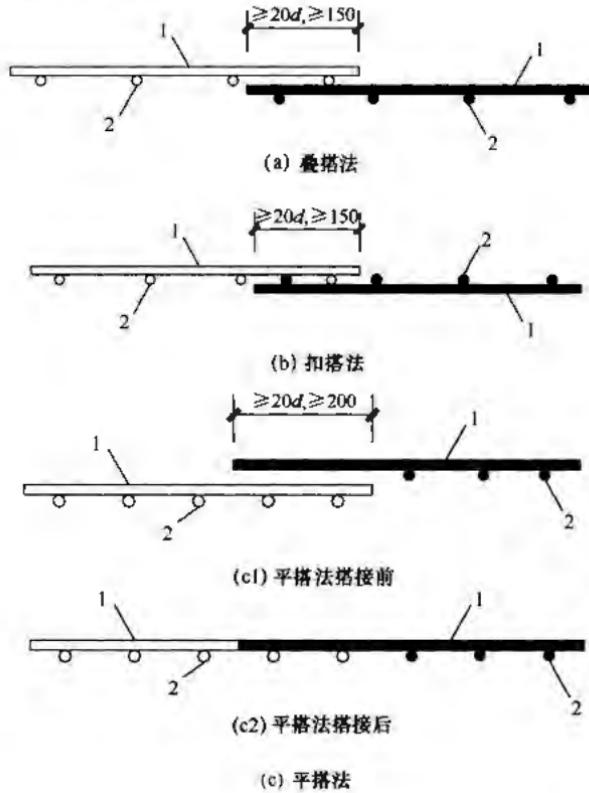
钢筋焊接网在非受力方向的搭接
